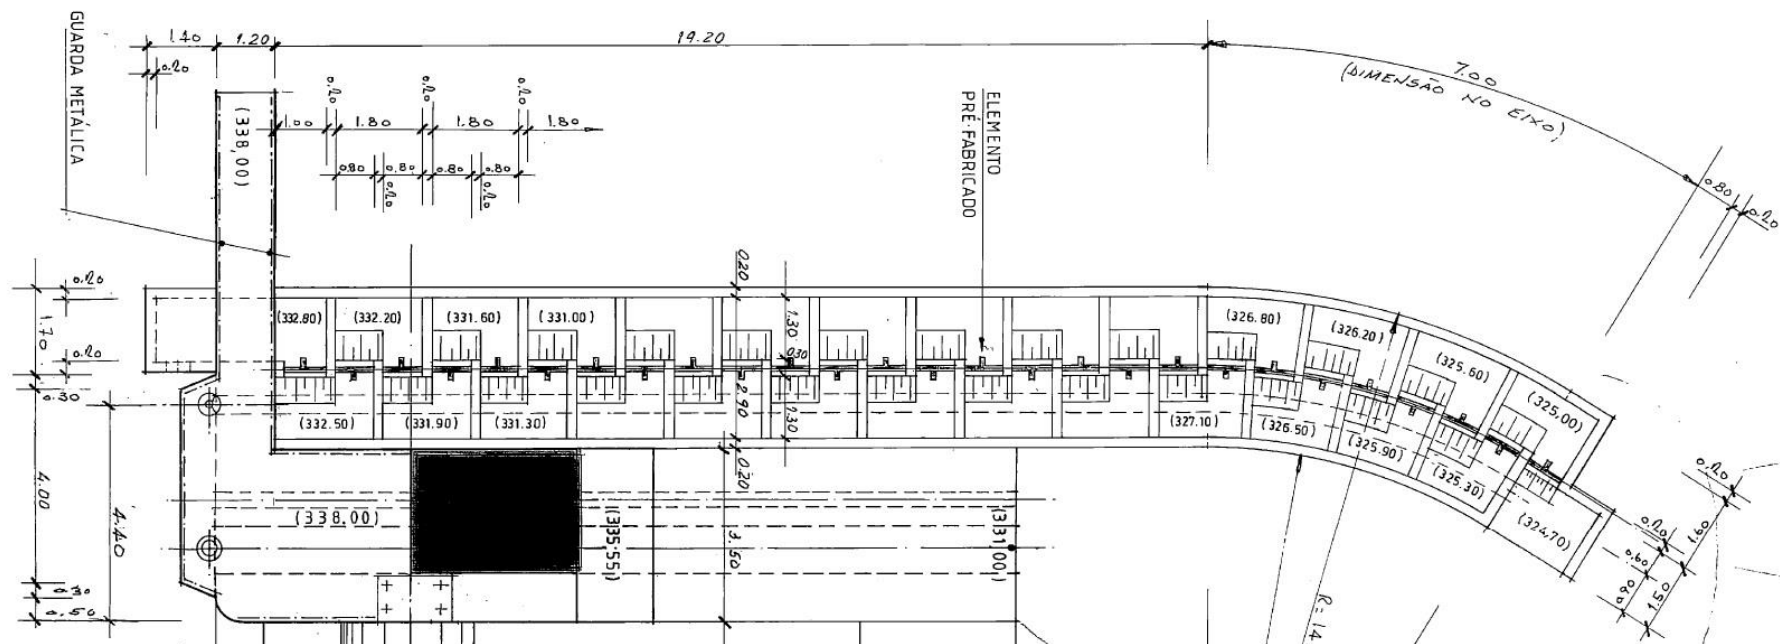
Vista em planta do dispositivo de passagem de peixes do A.H. Torga (adaptado do projeto)
